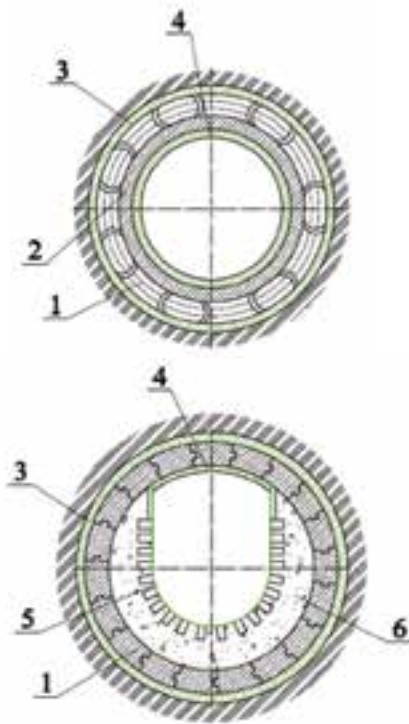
Коллекторы, выполняемые при закрытом способе строительства: 1 — керамические или бетонные блоки; 2 — железобетонная рубашка; 3 — бетонный (тампонажный) слой (с добавкой состава MasterGlenium®) для заделки стыков блоков; 4 — штукатурка из состава MasterEmaco® N 900; 5 — гидроизоляционные составы PCI® Barraseal или MasterSeal® 588; 6 — бетон
